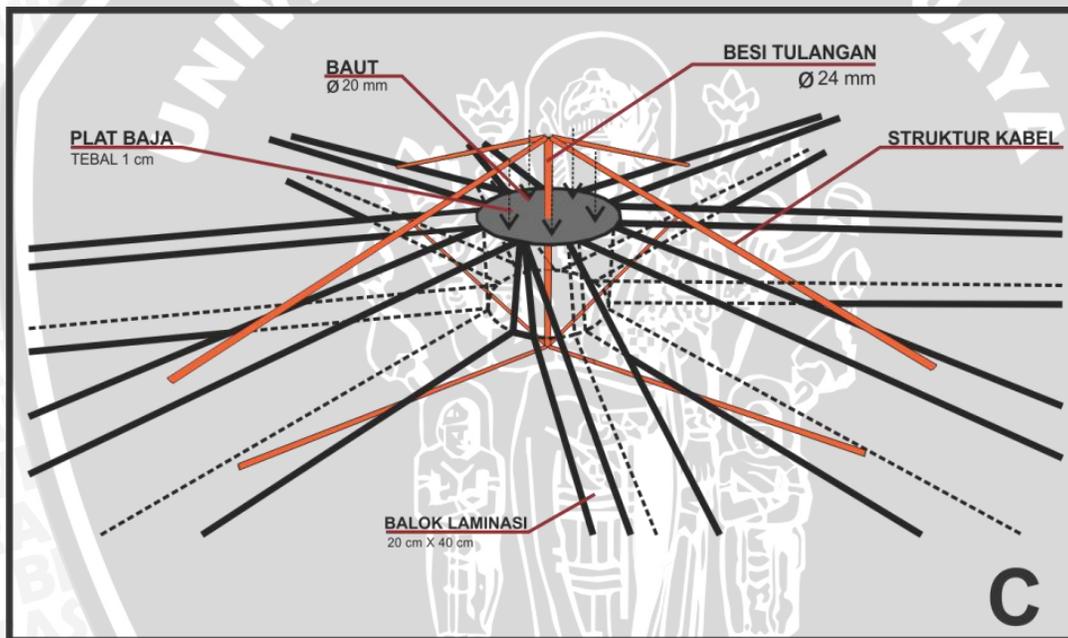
bentuk sambungan struktur rangka atap pada bangunan penerima.
